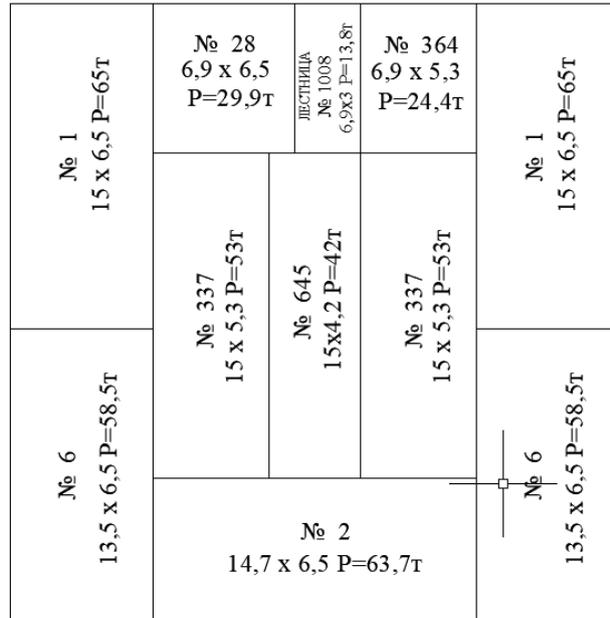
План раскладки КГОб на один этаж для жилого здания «Башня»
